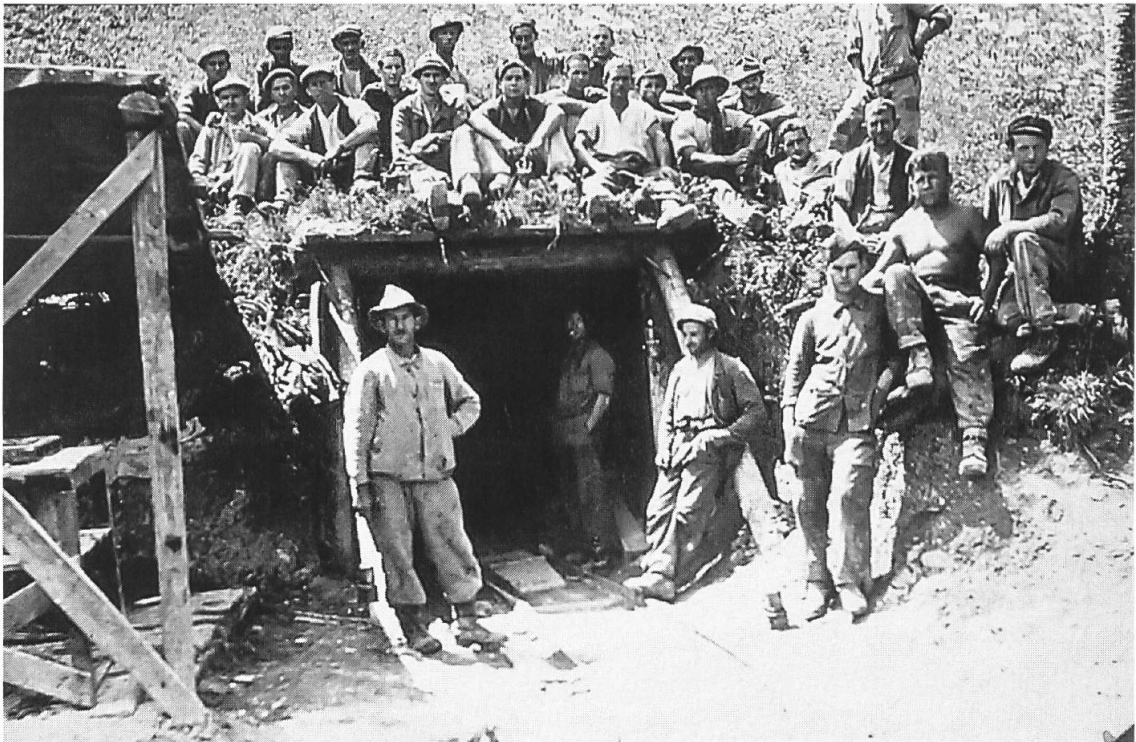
Die Mannschaft des Obersteiger Sulzer vor dem Götschihofstollen.
